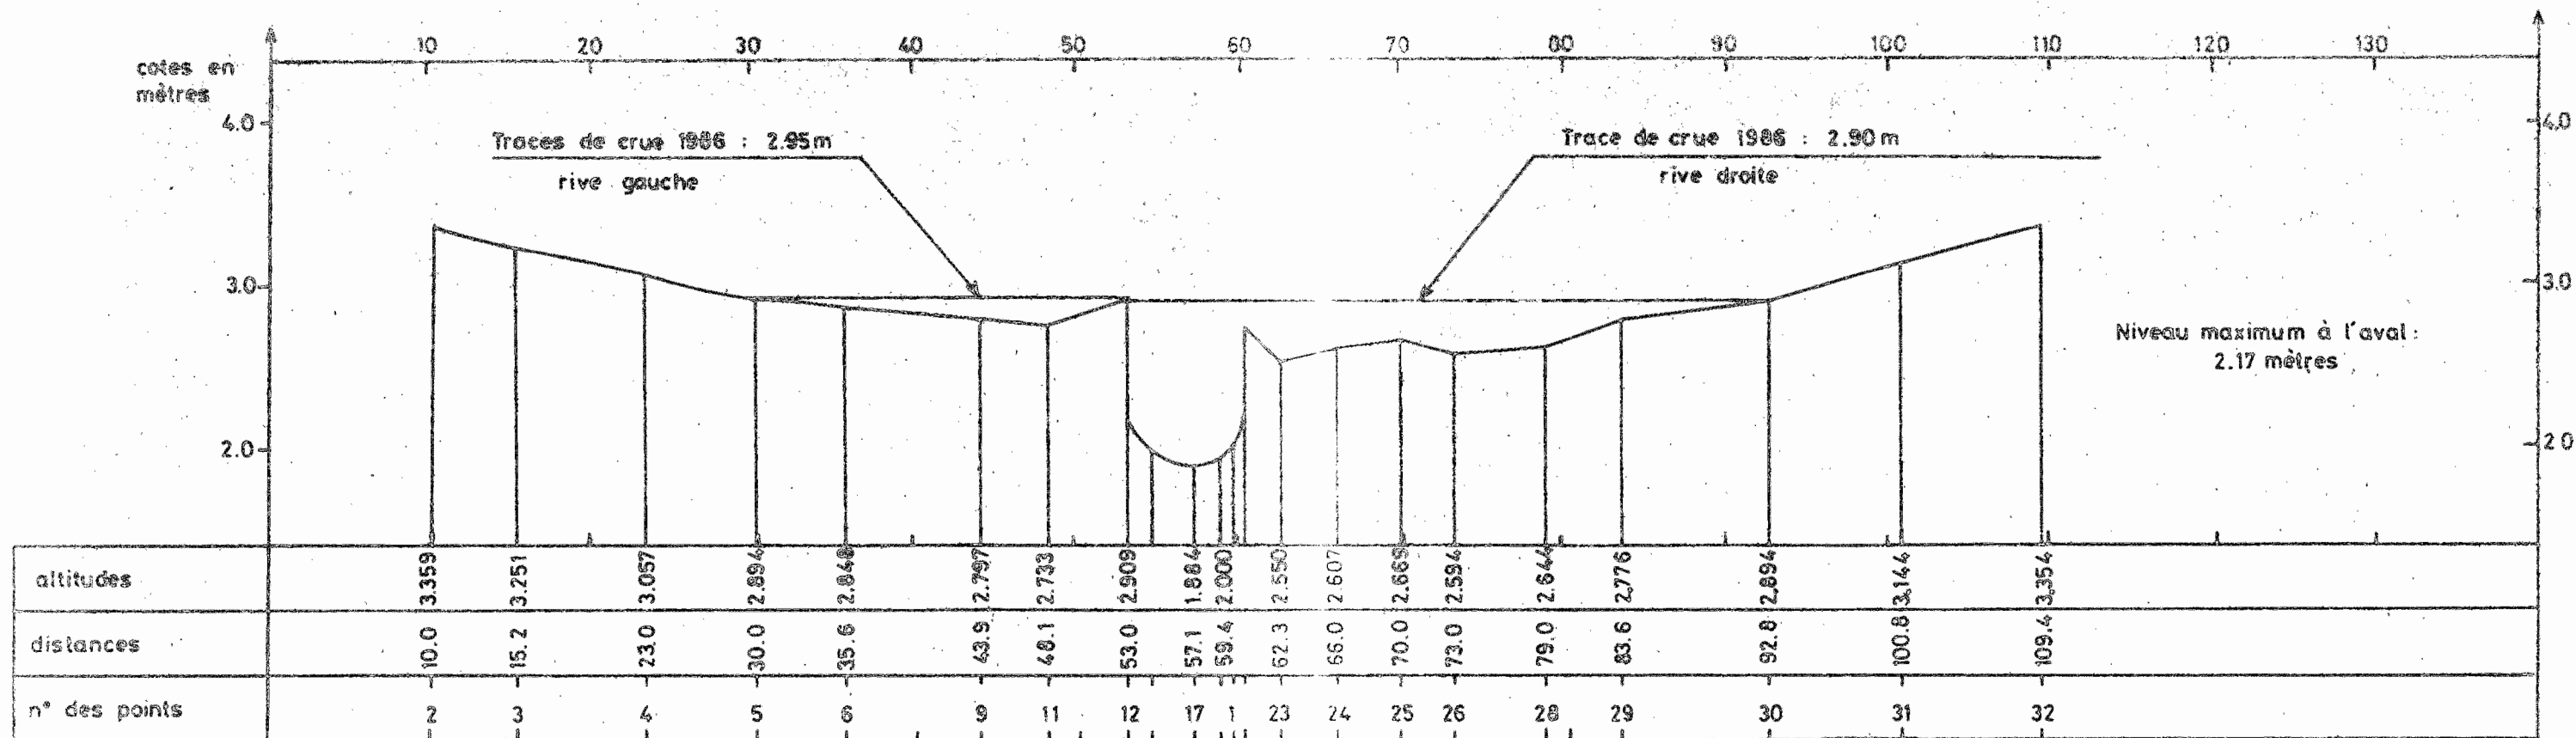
PROFIL EN TRAVERS DE L'AFFLUENT RIVE GAUCHE DU BLETOU Le 14 AVRIL 1987
